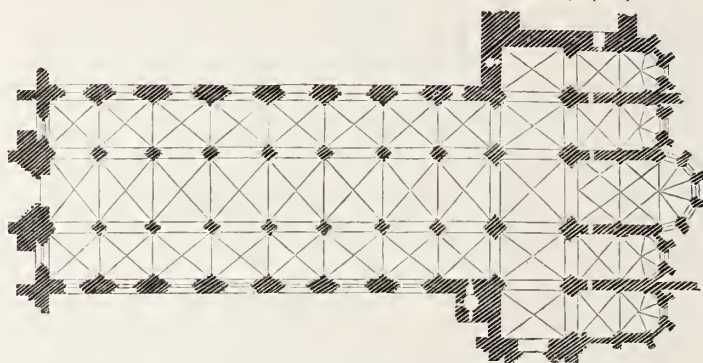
Grundriß der Klosterkirche zu Batalha.
